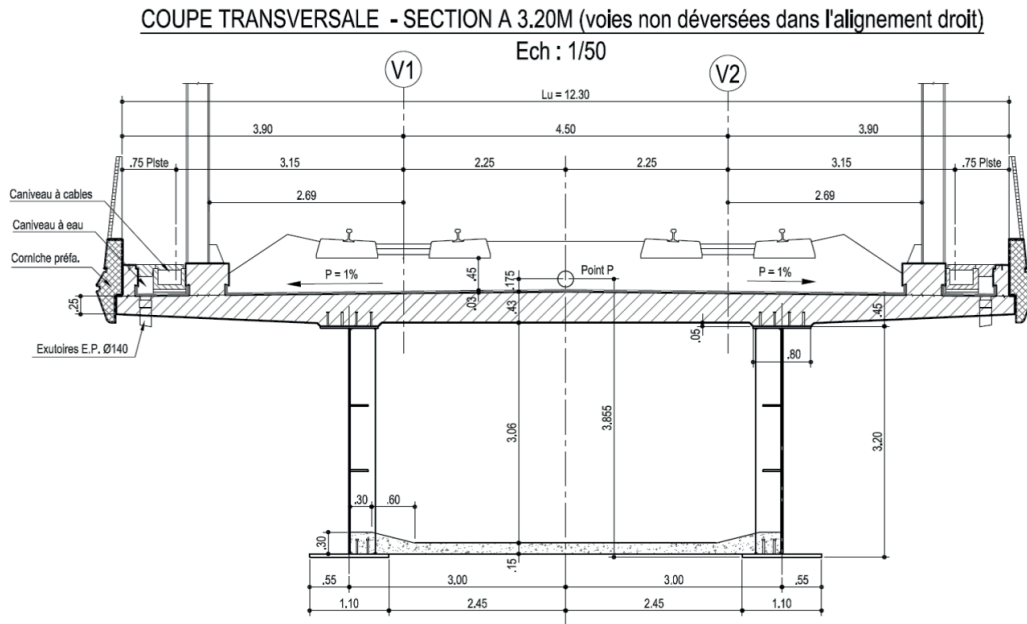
Coupe transversale en travée de la section, dimensions en m.
